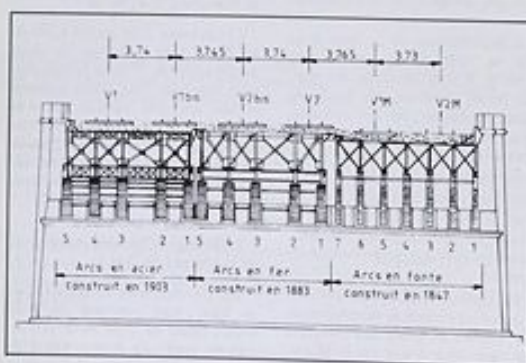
Coupe transversale de l'ouvrage existant sur l'autoroute A4.
